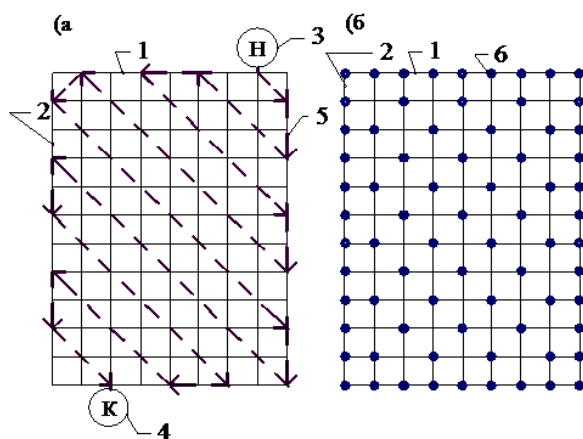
Порядок закрепления арматурных стержней вязальной проволокой: а) схема движения рабочего вязущего пересечения стержней; б) схема закрепления стержней арматурной сетки: 1-поперечные стержни; 2 – продольные стержни; 3 – начало пути рабочего; 4 – окончание пути рабочего; 5- путь движения рабочего; 6 – пересечение арматурных стержней, закрепленное вязальной проволокой
